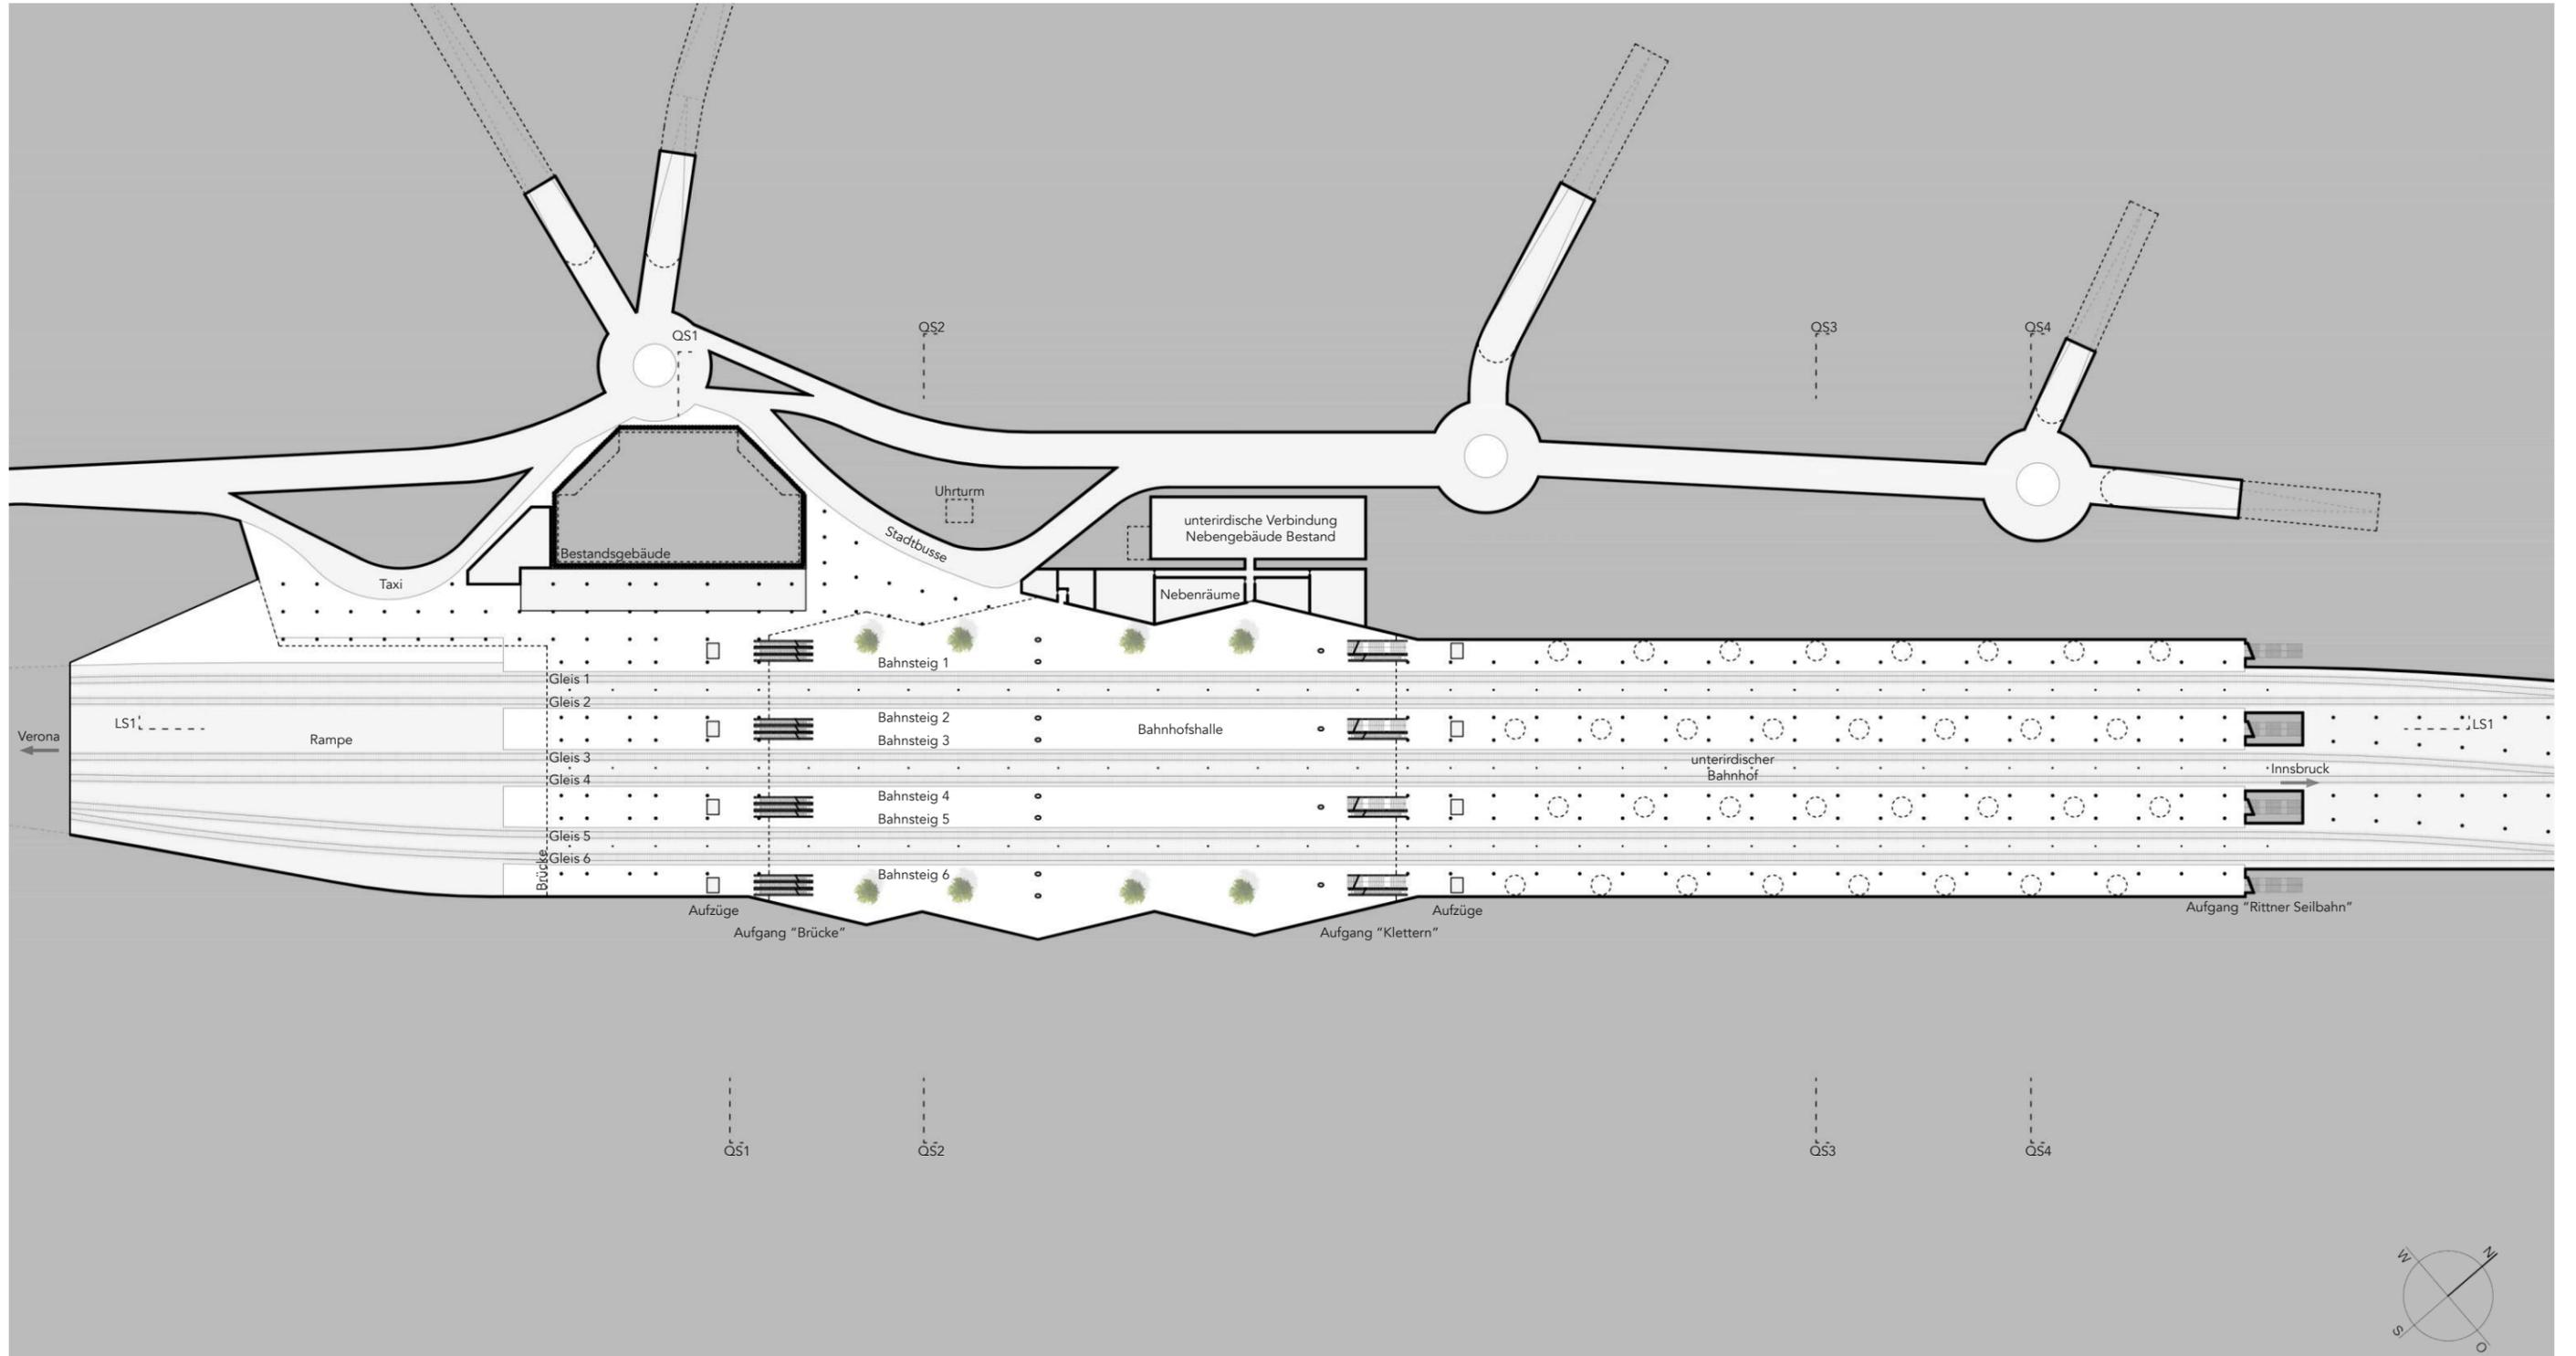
Grundriss Untergeschoss 1:1500
